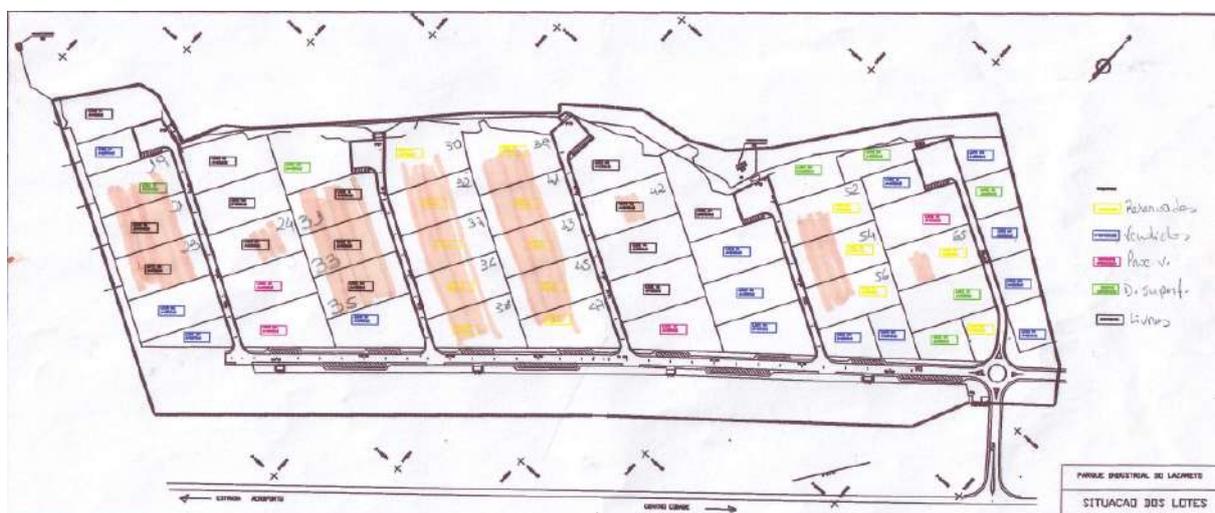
Planta e situação dos lotes do Parque Industrial de Lazareto.
